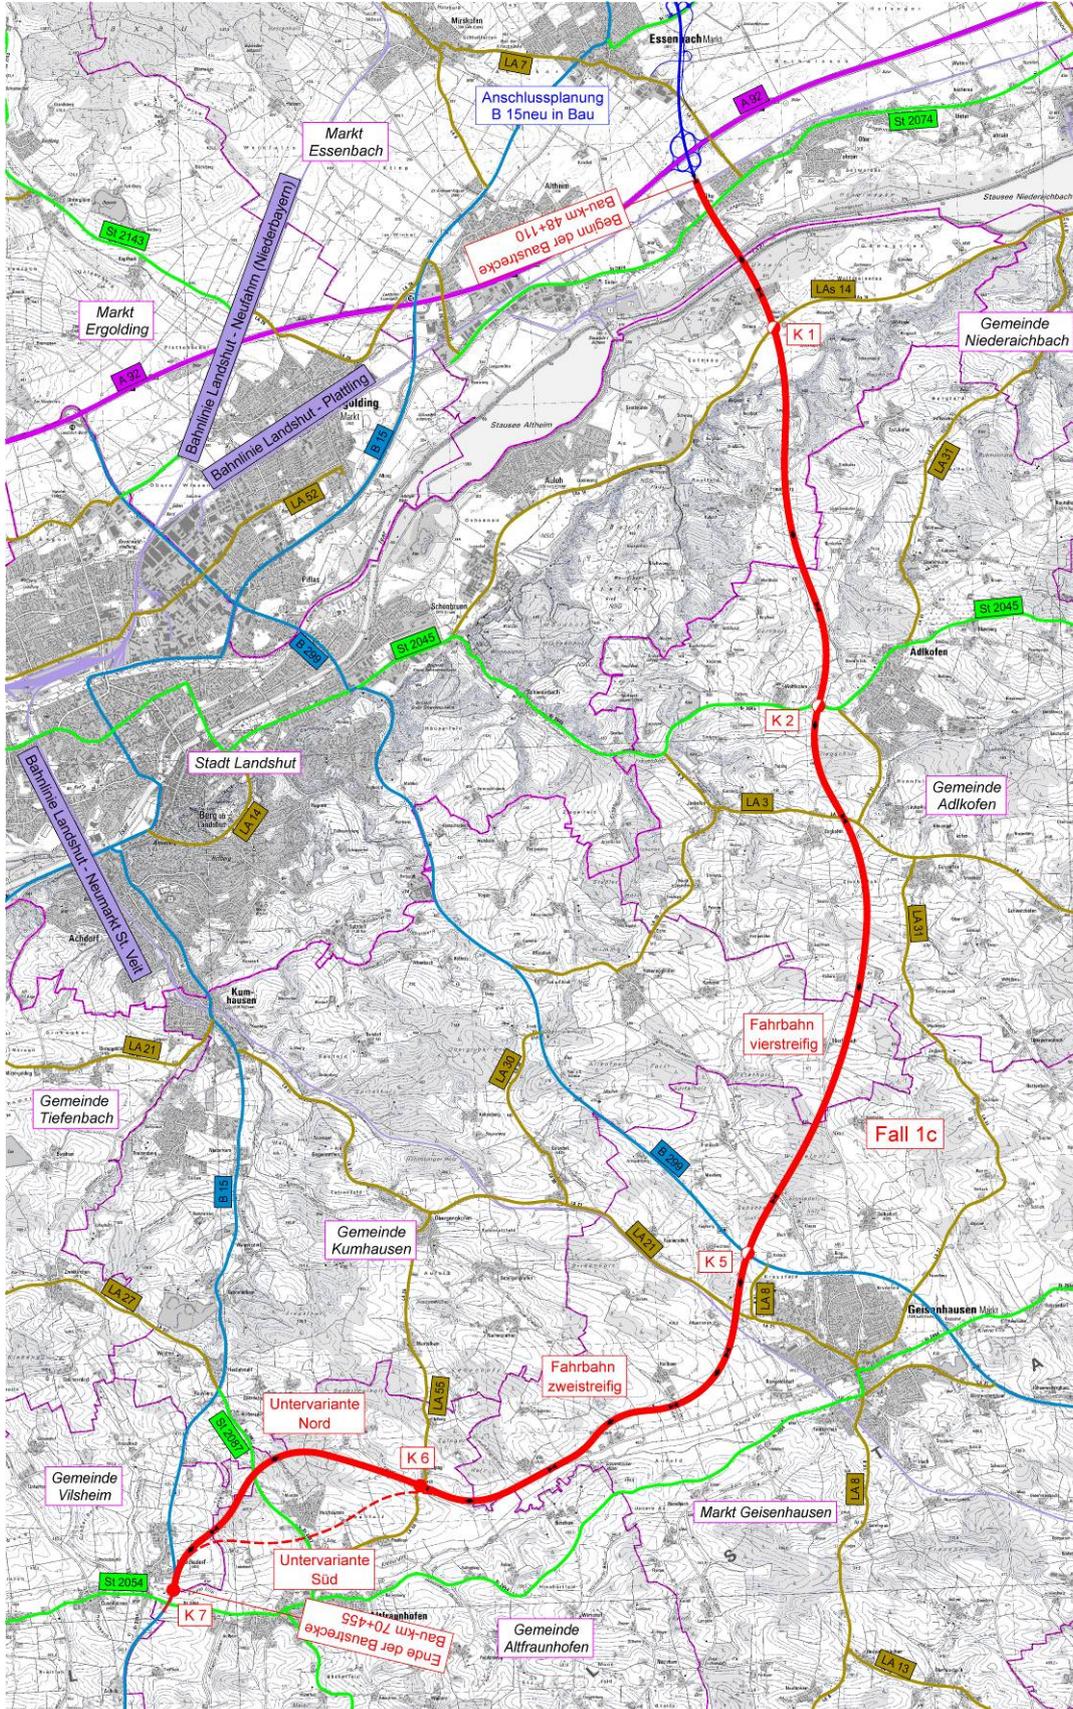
Lageplan Planfall 1c (Unterlage 3, Blatt 4)
